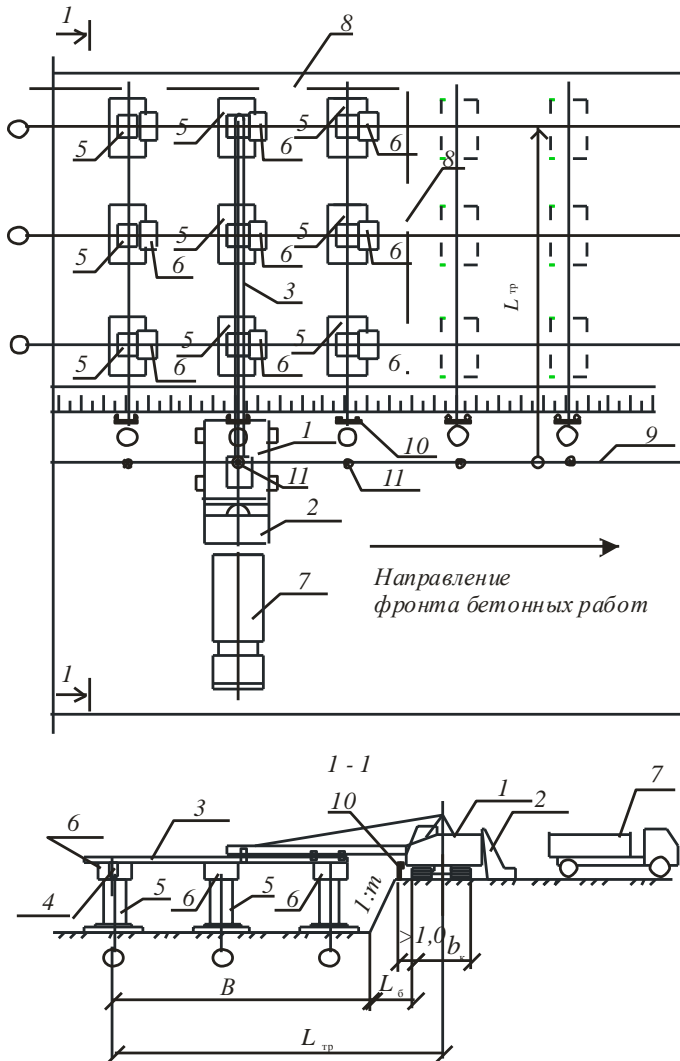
Технологическая схема бетонирования фундаментов при помощи бетоноукладчика:
